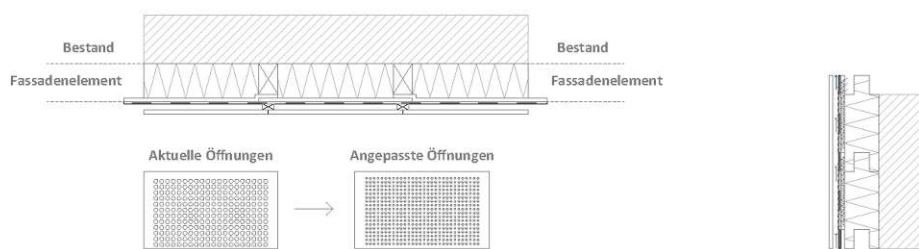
V1 Detailansicht Fertigmodul mit Lattung und Verkleidung
